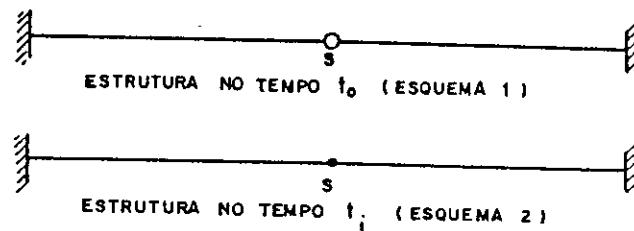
ESTABELECIMENTO DO IMPEDIMENTO DA
